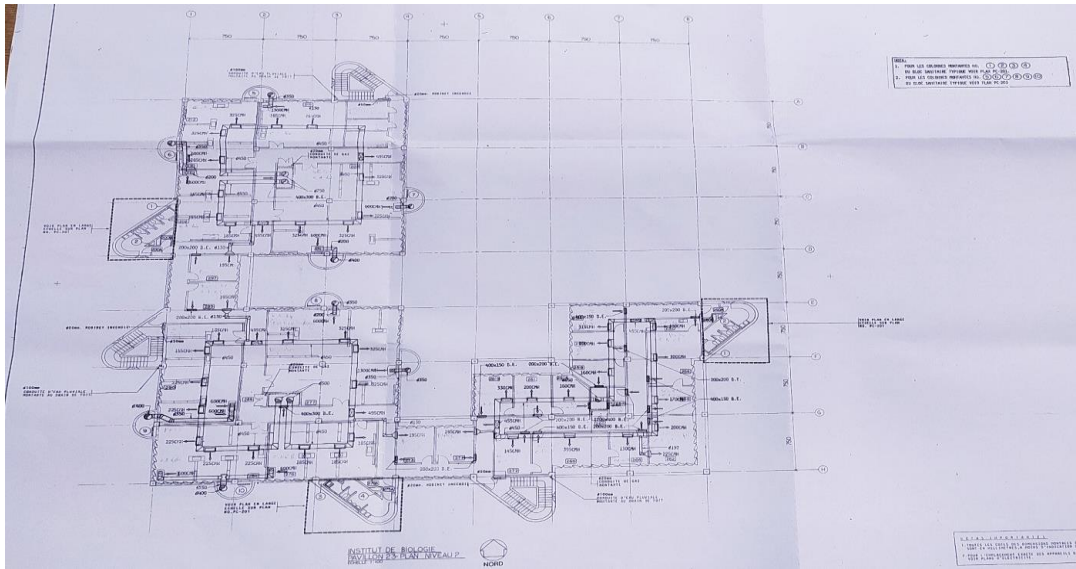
plan d'architecture de niveau 1 du département 23
